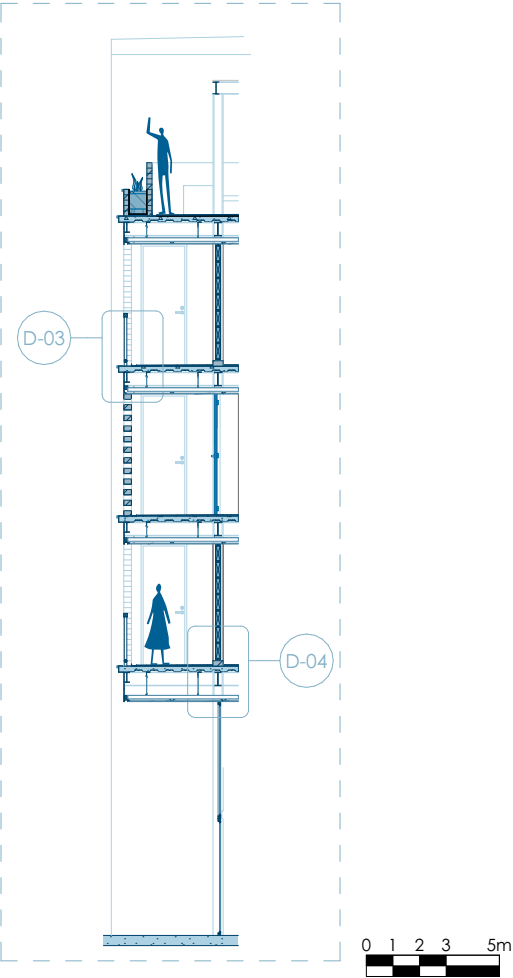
Sección constructiva B. Nota. Elaboración propia.
